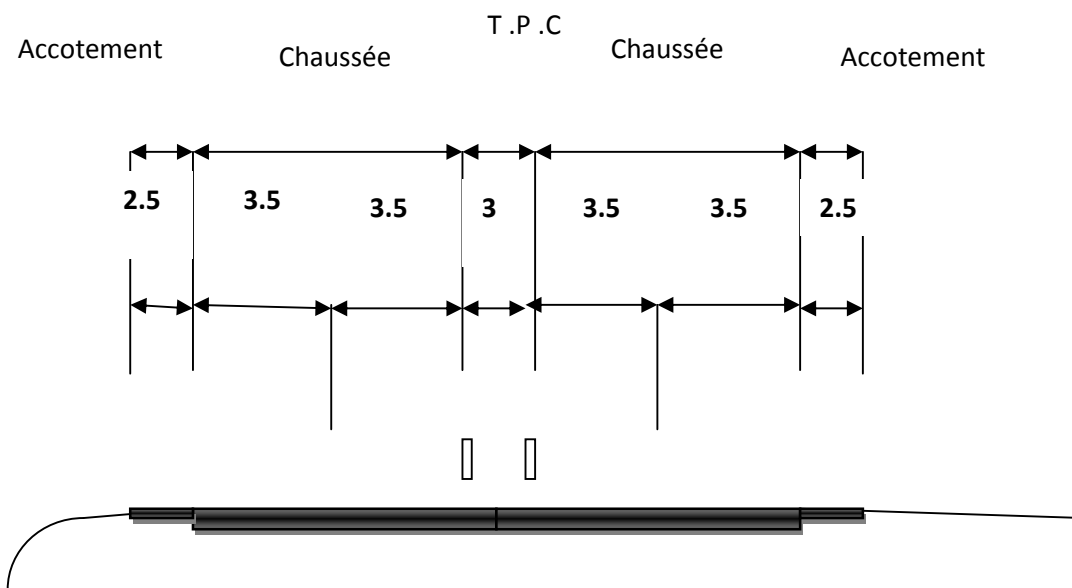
Schéma explicatif d'une coupe transversale de la chaussée
